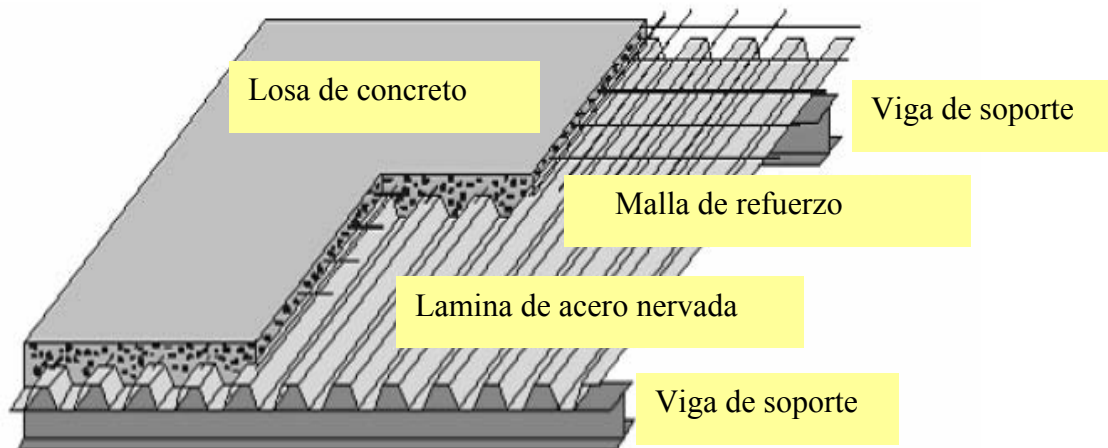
Componentes de un sistema de piso losacero soportado por dos vigas.
